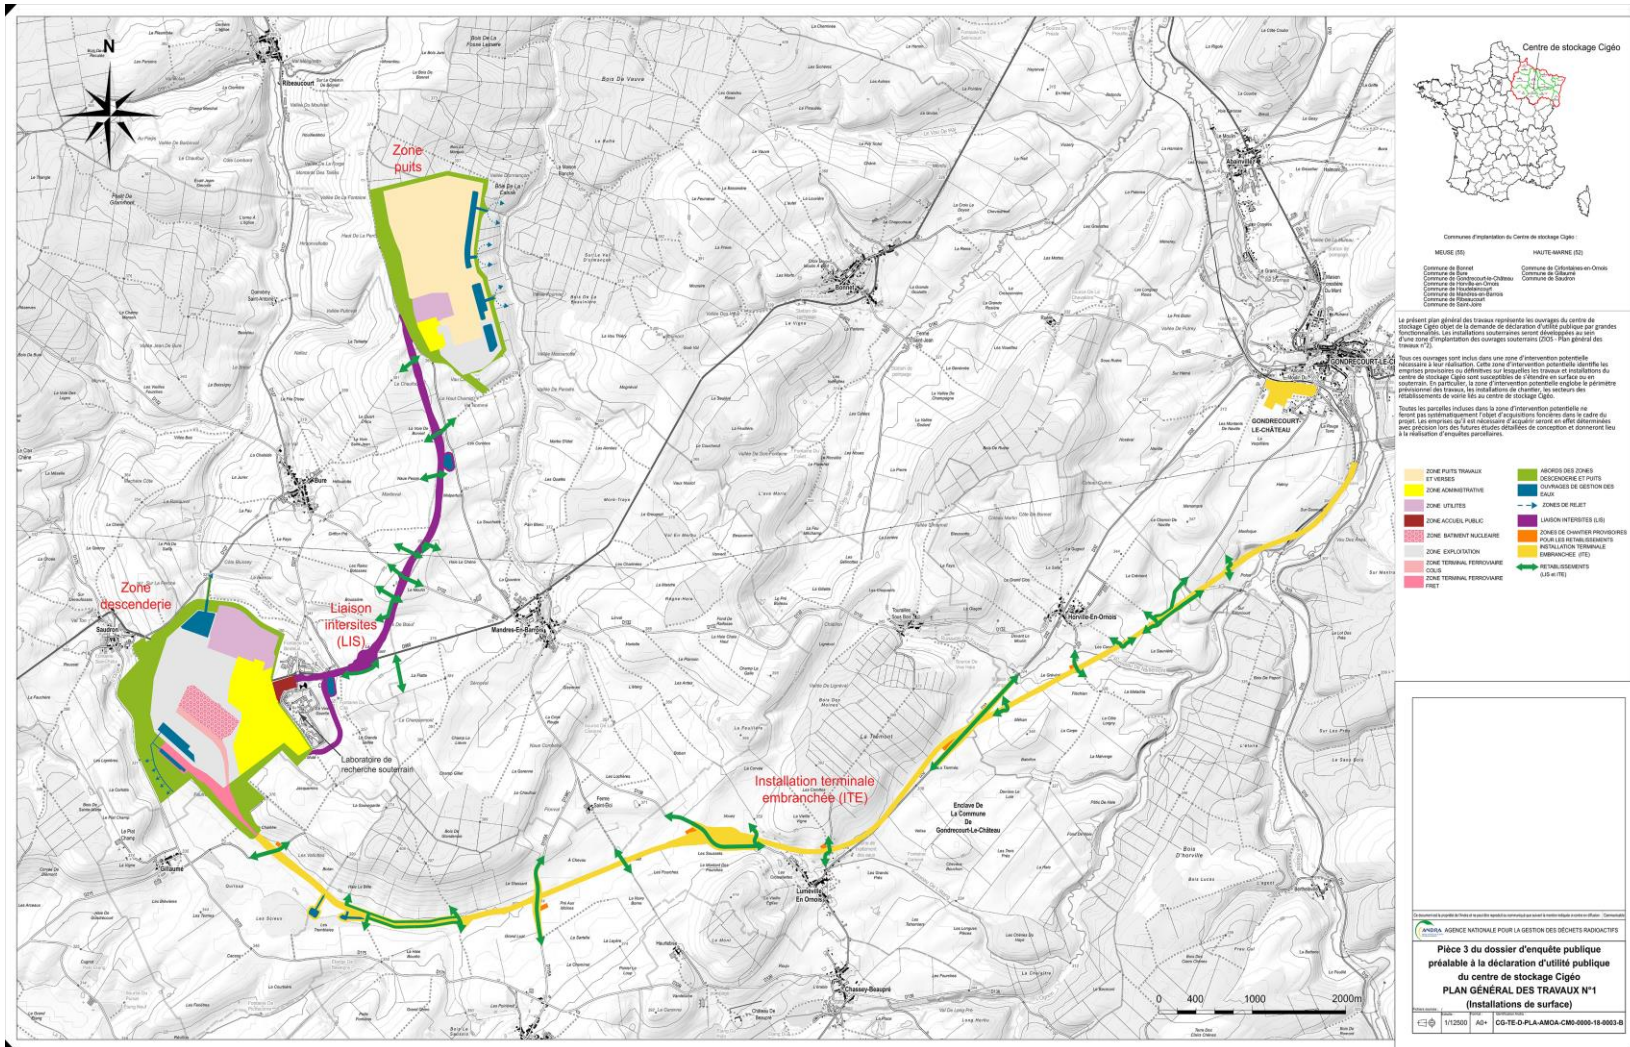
Plan général des travaux n°1 (installations de surface) annexe au décret n° 2022-993 du 7 juillet 2022
